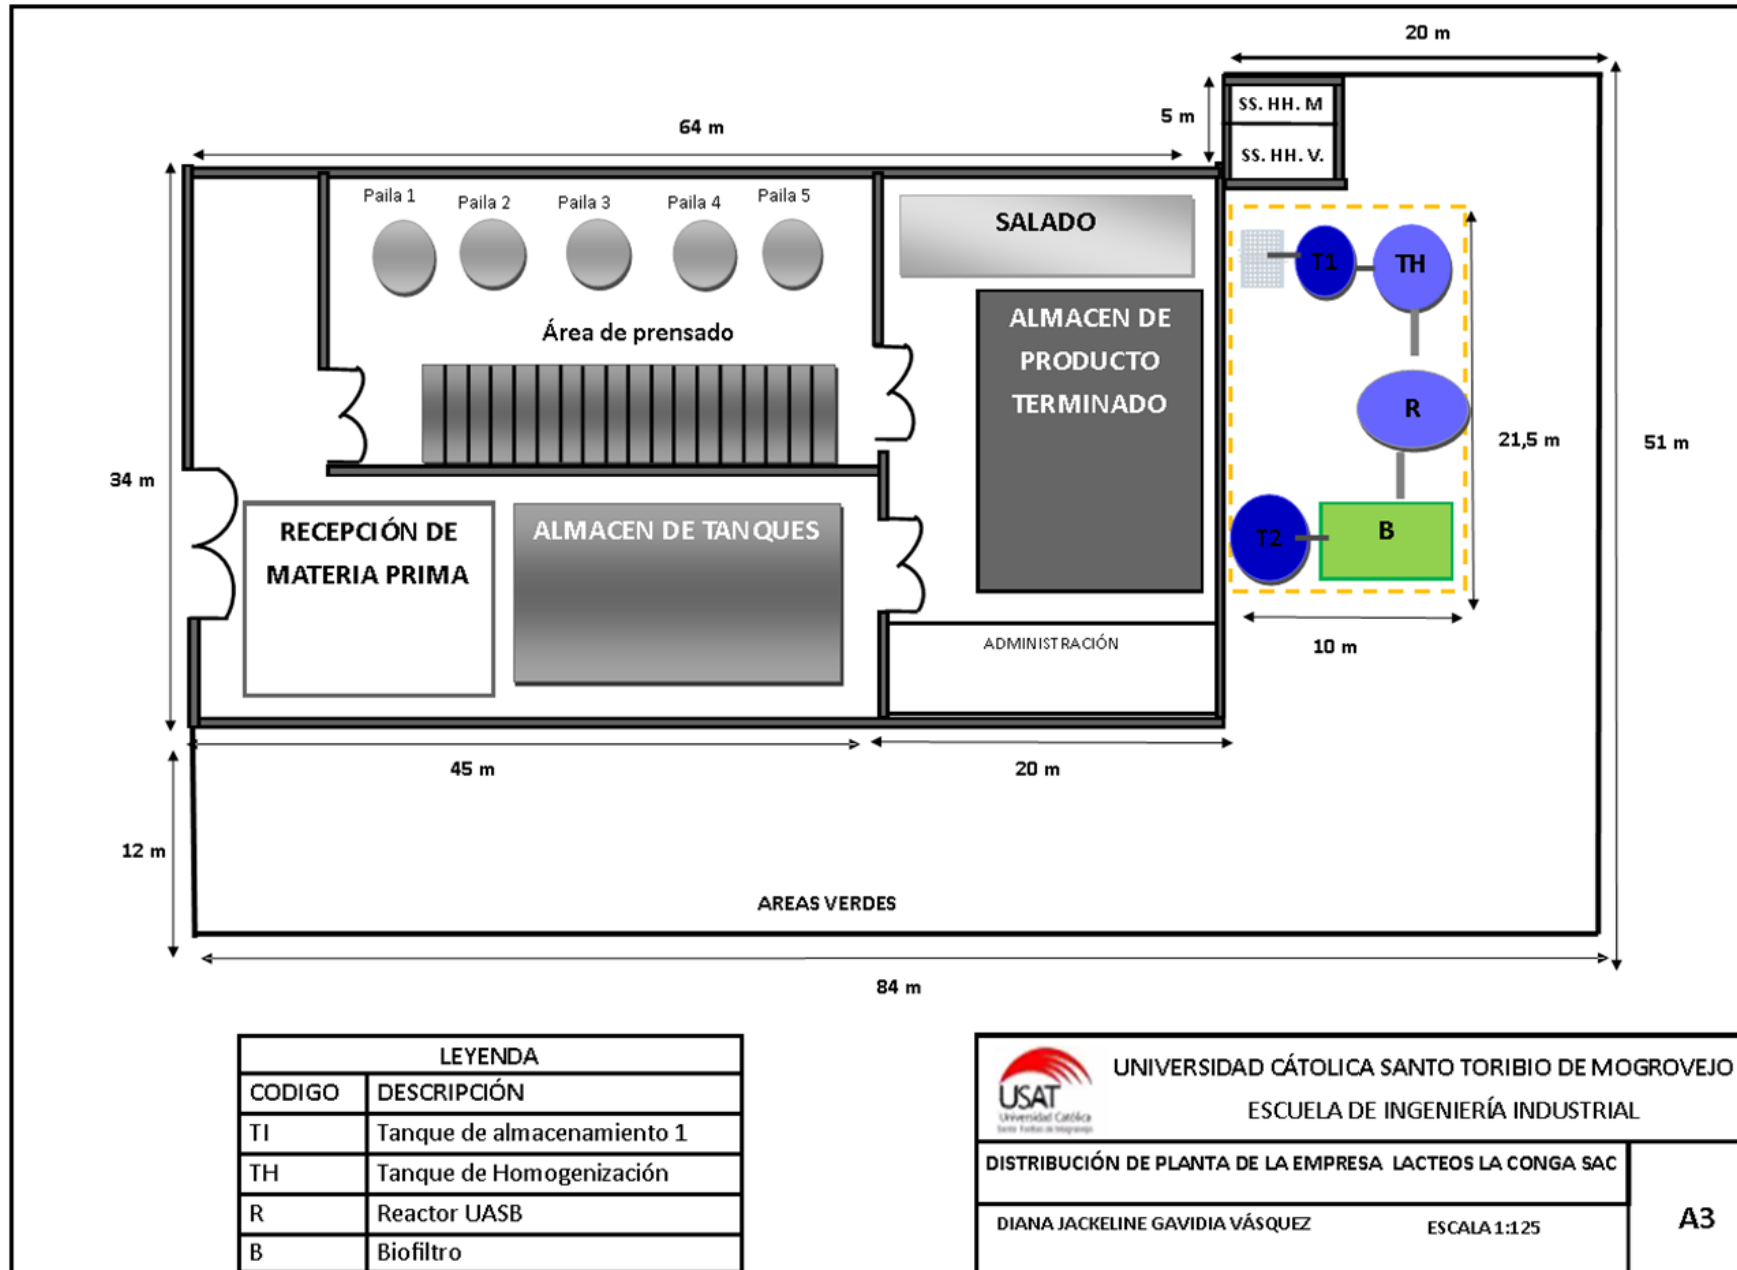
Plano de la planta Láctea incluyendo el sistema de tratamiento.
